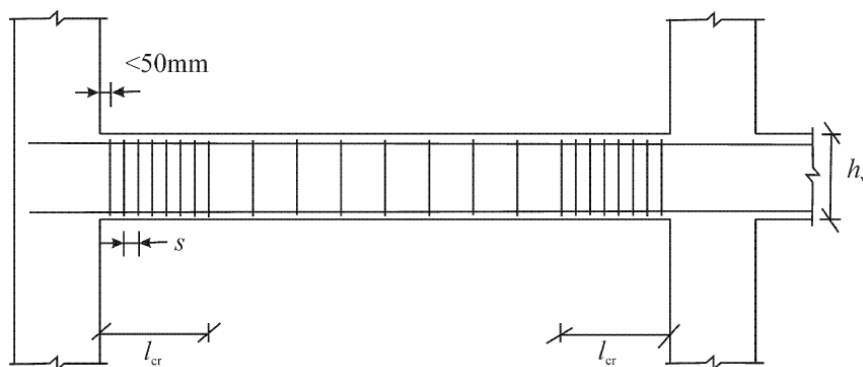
Armaduras transversais nas zonas críticas das vigas
